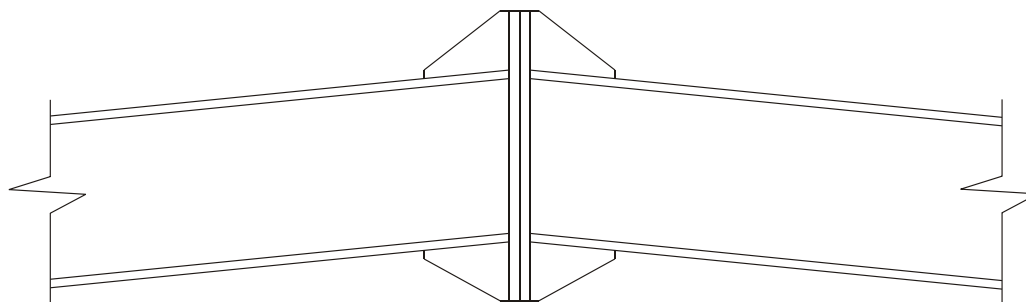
Nó do Pórtico para Duplo Pavilhão
